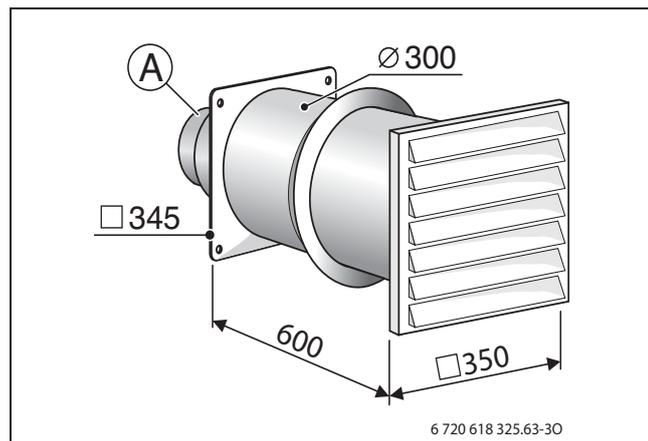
Dimensioni della bocchetta parete WG 160/1 (dimensioni in mm)
